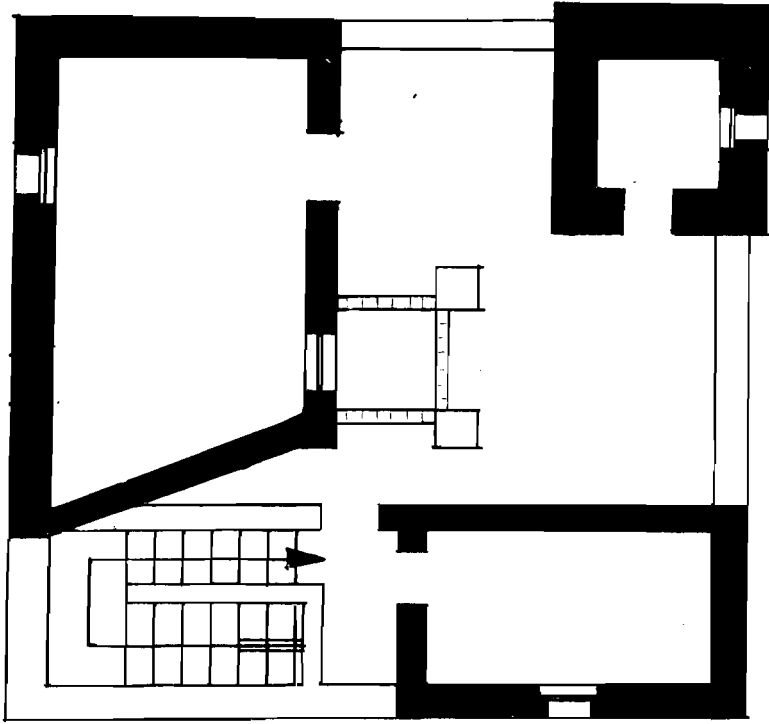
Plan du second étage. Une partie seulement est construite. Dans l'angle droit, en haut, le *lborj*.
